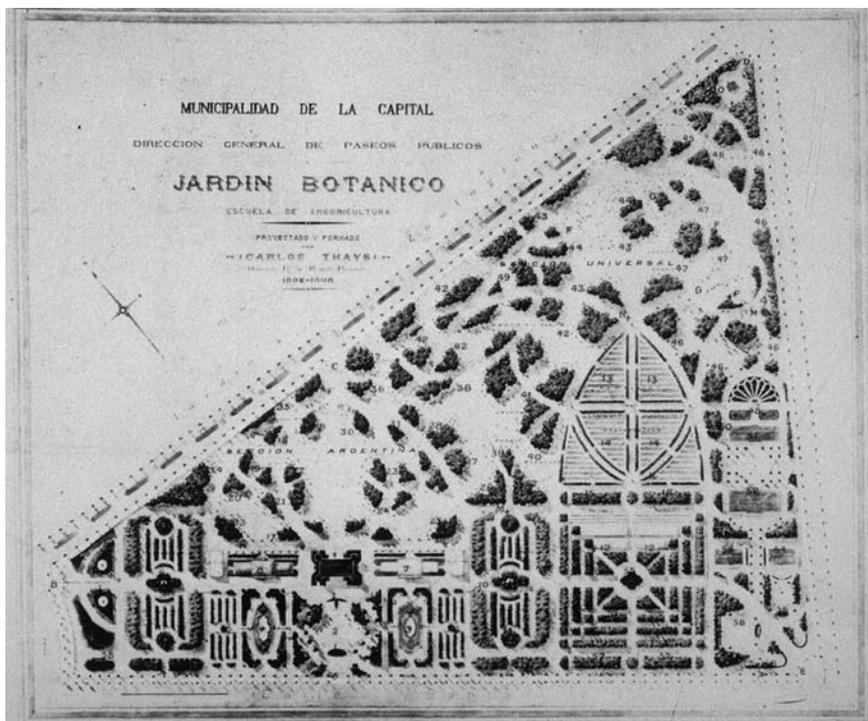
A: Jardín Botánico de Buenos Aires. Plano 1898
